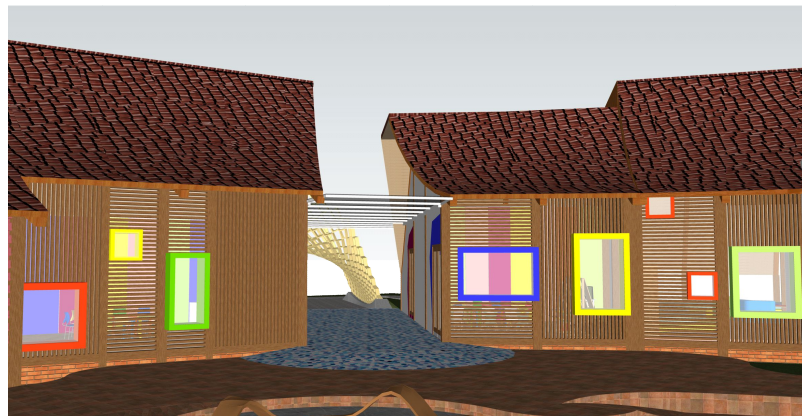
3D Aksonometri Massa Bangunan Keempat
